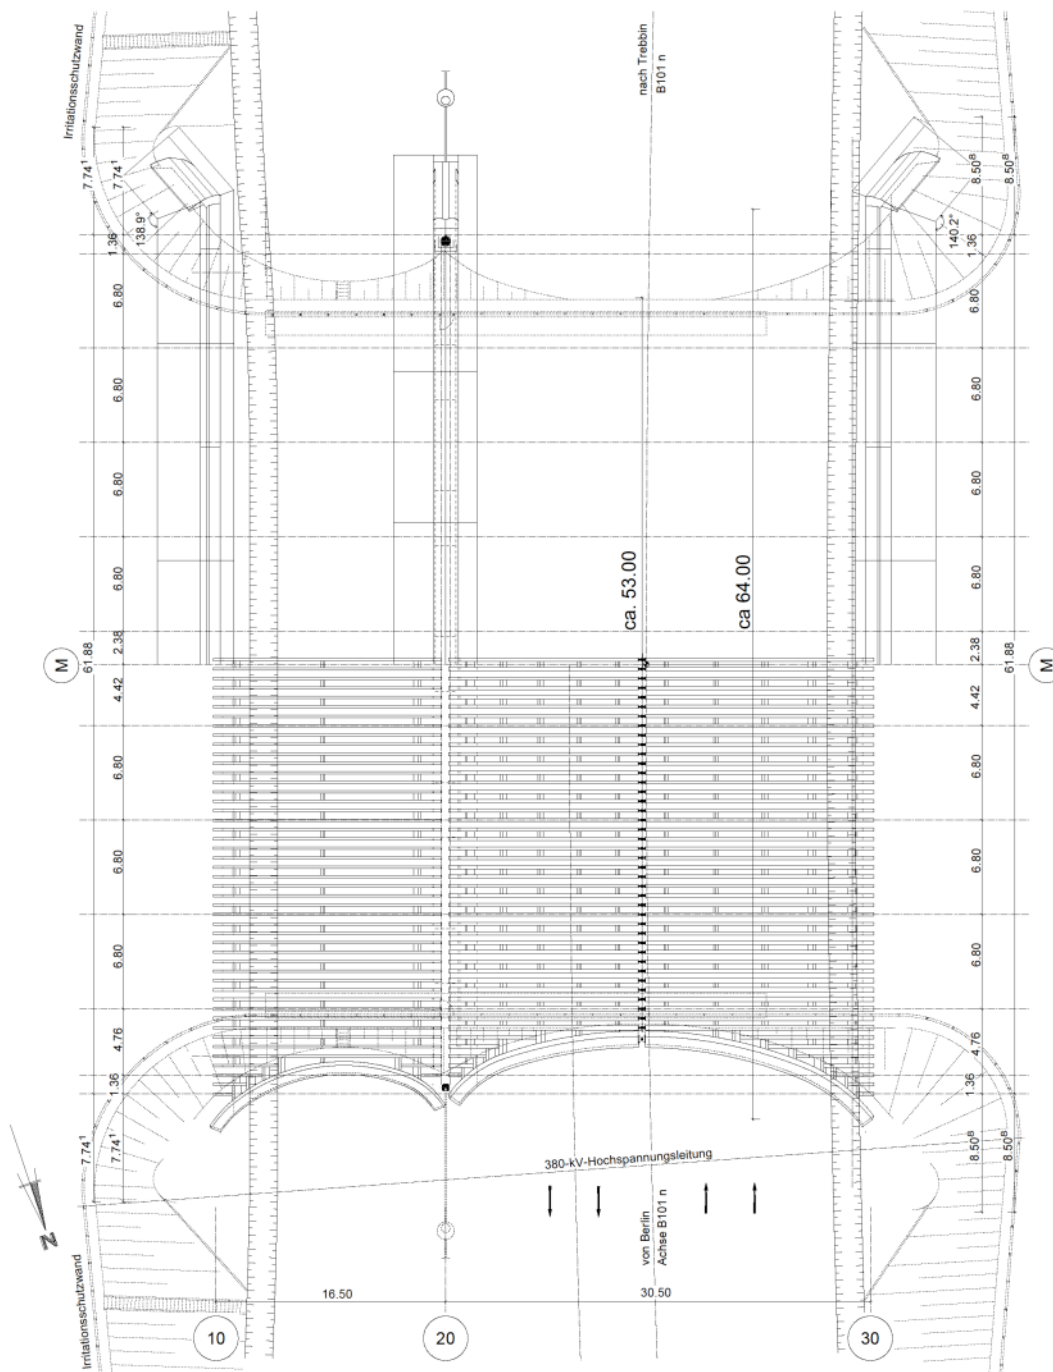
Grundriss der Grünbrücke Thyrow
